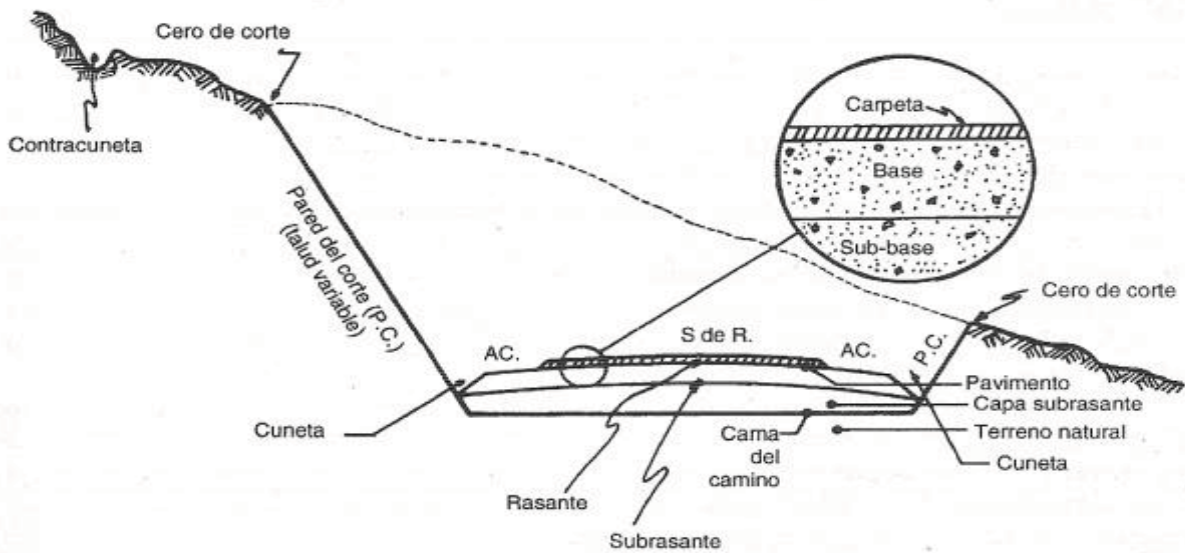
Sección transversal típica en corte para carreteras de dos carriles.
